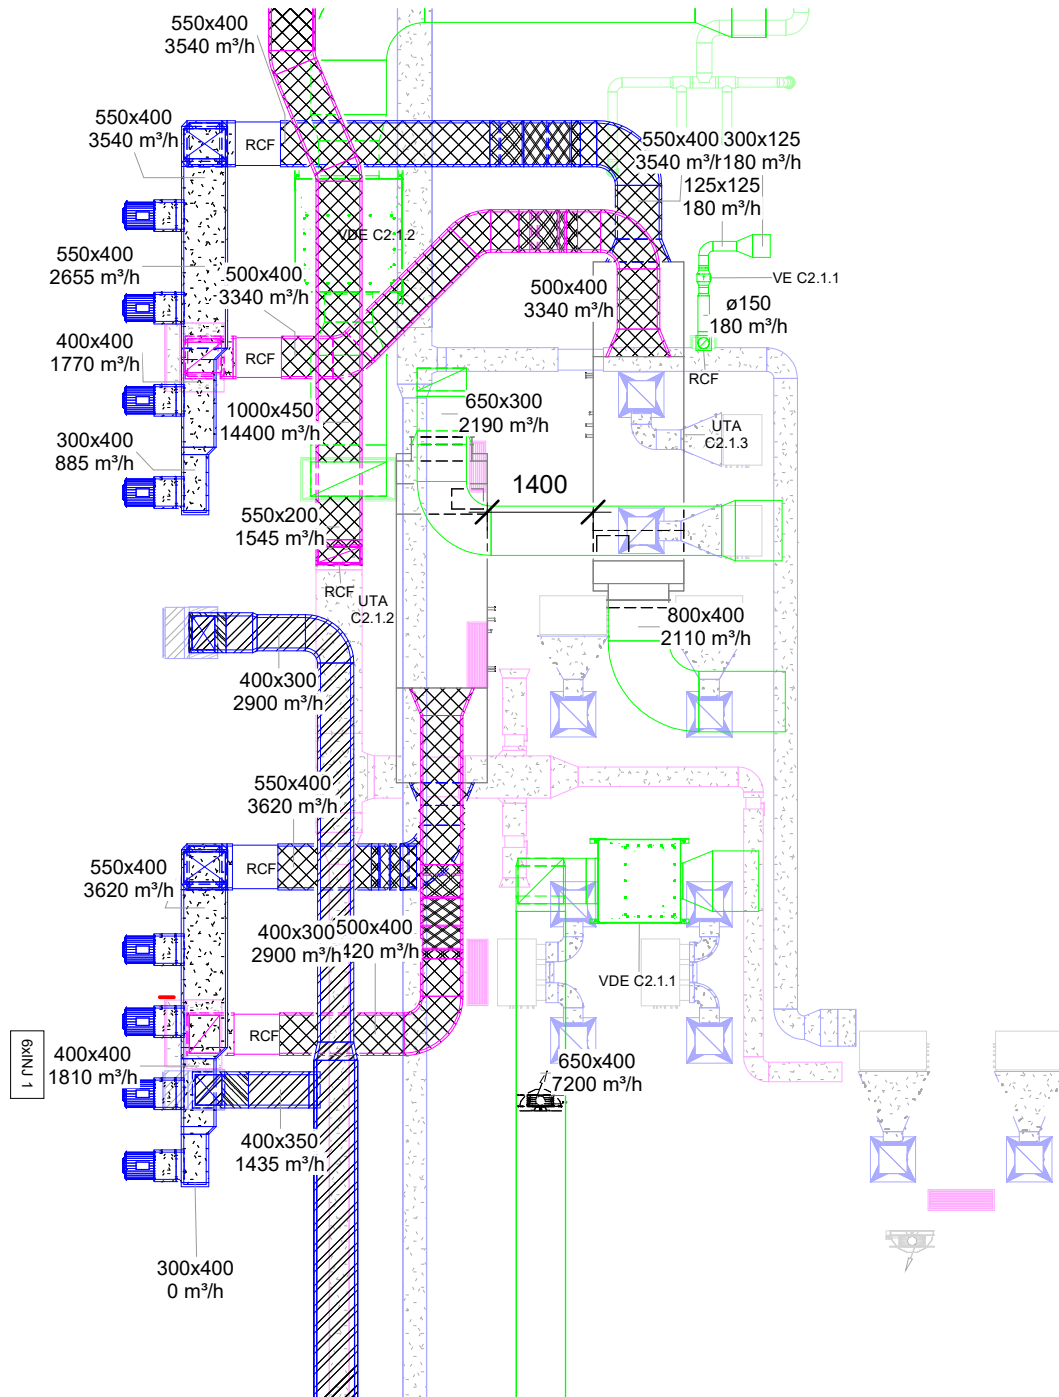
Seção 2.6 da planta geral do traçado das condutas na mezzanine à escala 1:100.
